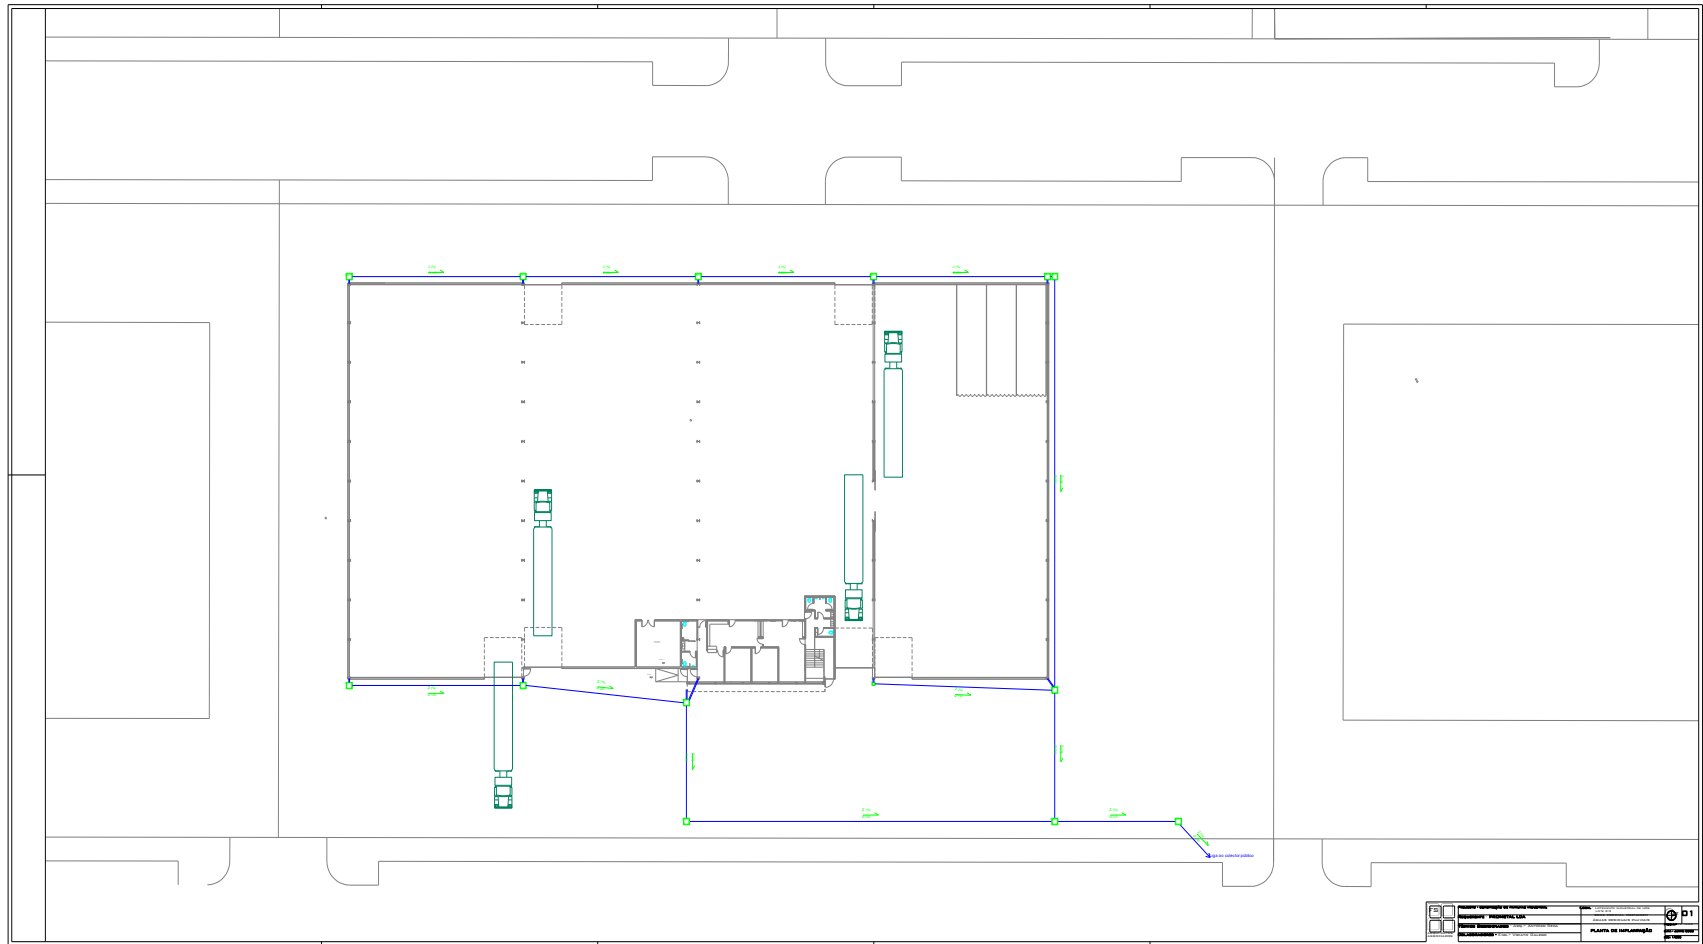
Planta da rede predial de drenagem de águas pluviais – Implantação
